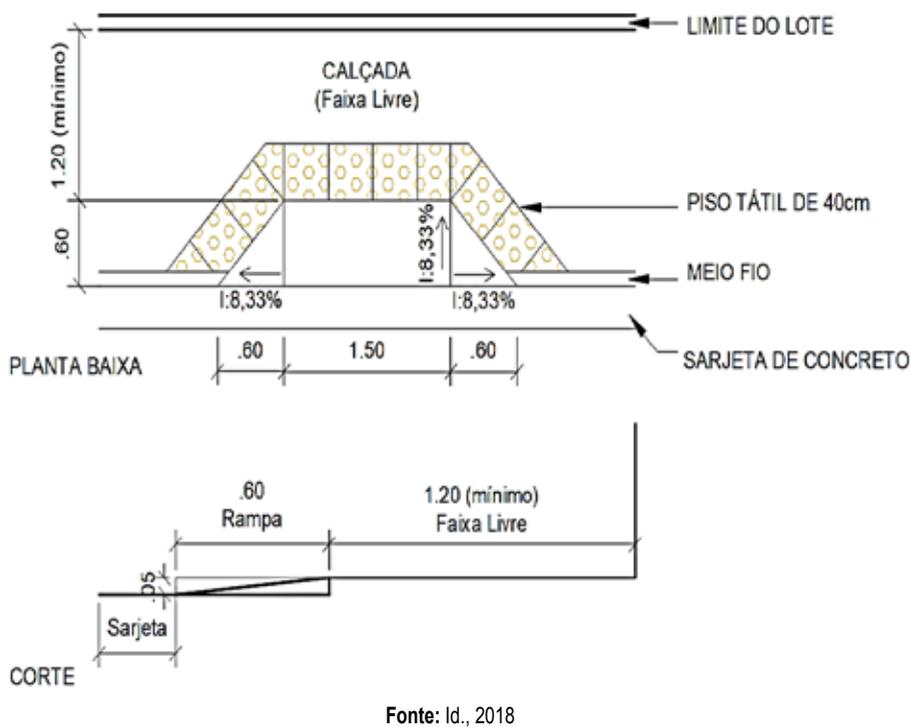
Planta baixa e corte da rampa transversal para calçada com altura de 7 cm
